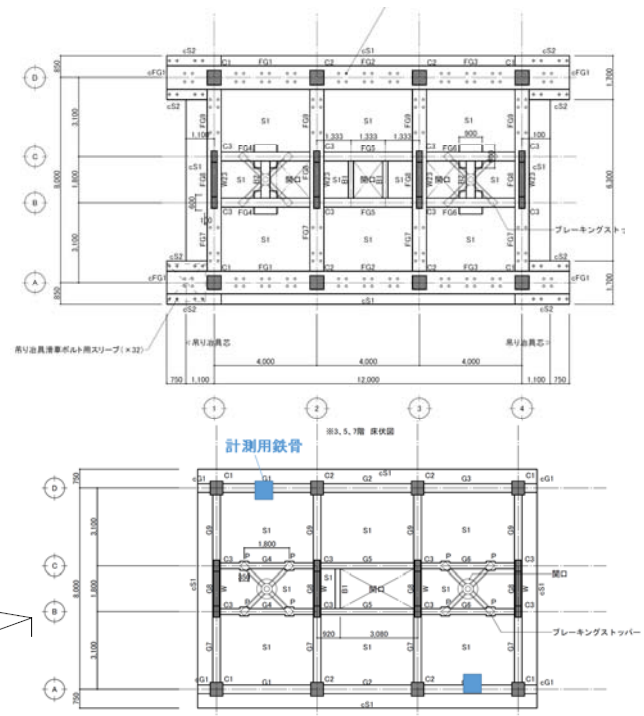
平面図 (上 : 1 階、下 : 2～10 階)
